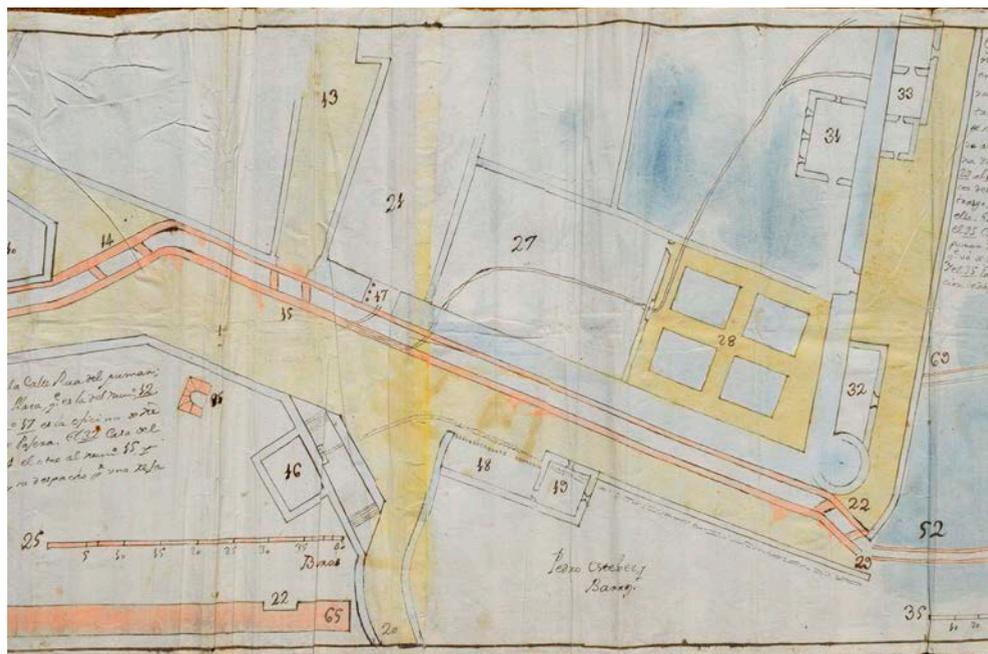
Plano de Mondoñedo. En tono salmón se aprecia la planta y alzado de la acequia. Los números 14, 15 y 22 corresponden a los puentecillos de cantería ideados para cruzar el río; el 85, ubicado junto a la Fuente Vieja (nº 16), al alzado de dichos puentes.
